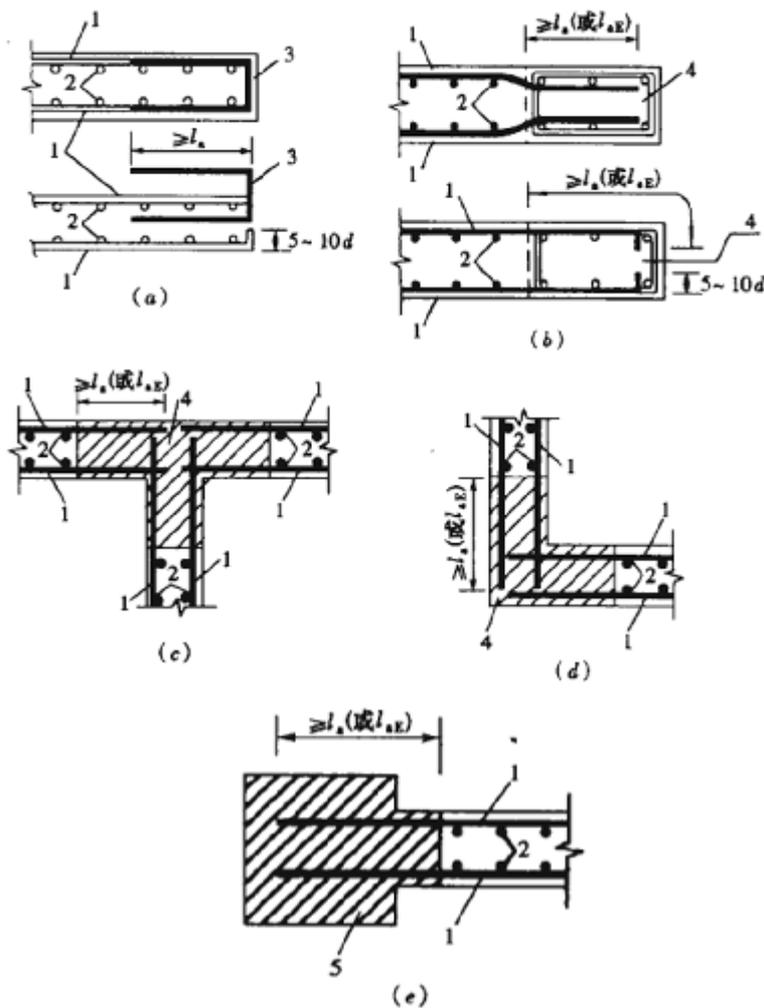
钢筋焊接网在墙体端部的构造
